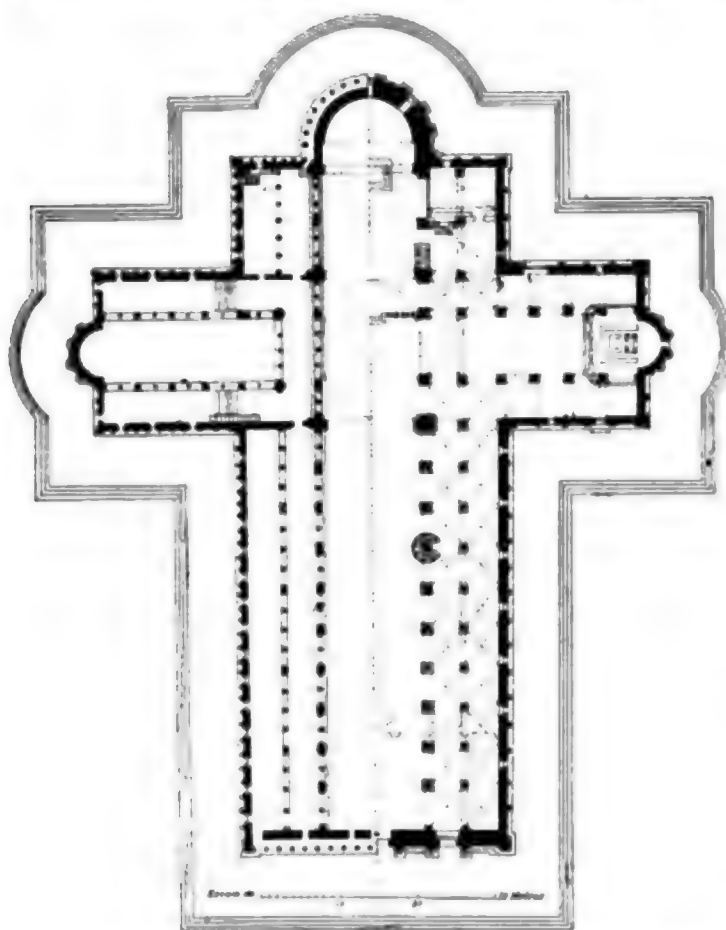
Planta de la catedral de Pisa. (A la derecha la planta baja y la de la izquierda al nivel de las galerías.)
